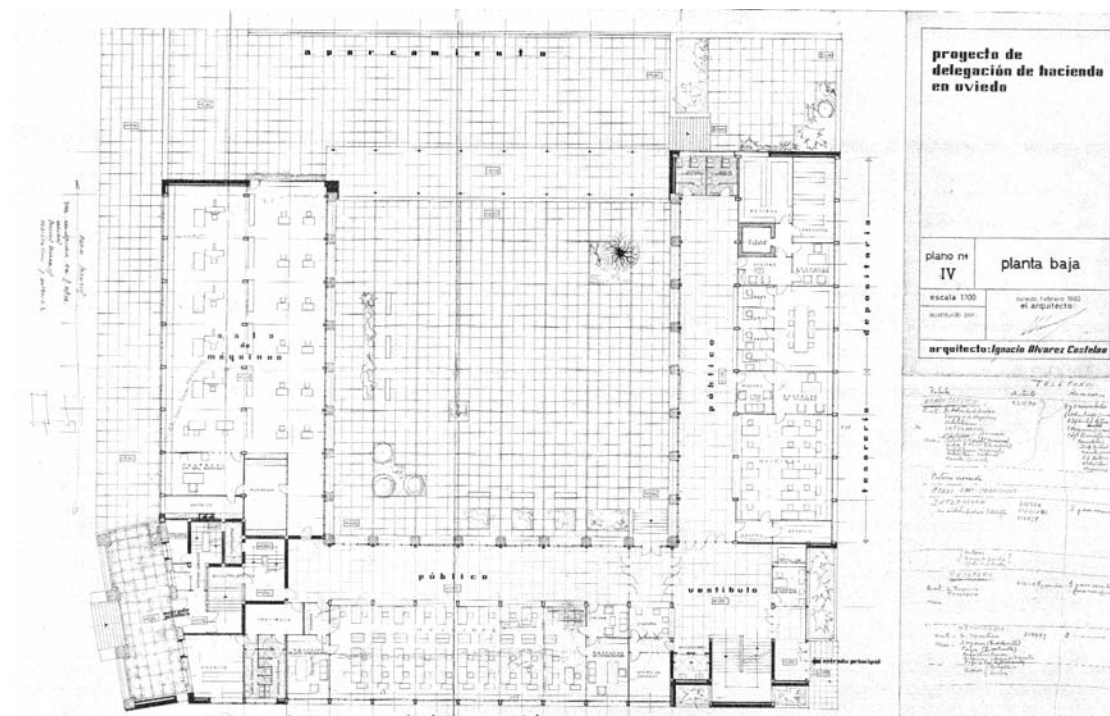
Proyecto de Delegación de Hacienda en Oviedo, 1960. Arquitecto, Ignacio Álvarez Castelao. Delineante, Antonio Trelles. Planta baja. (Archivo Histórico de Asturias, Delegación Provincial de Hacienda, caja 38537/1).
